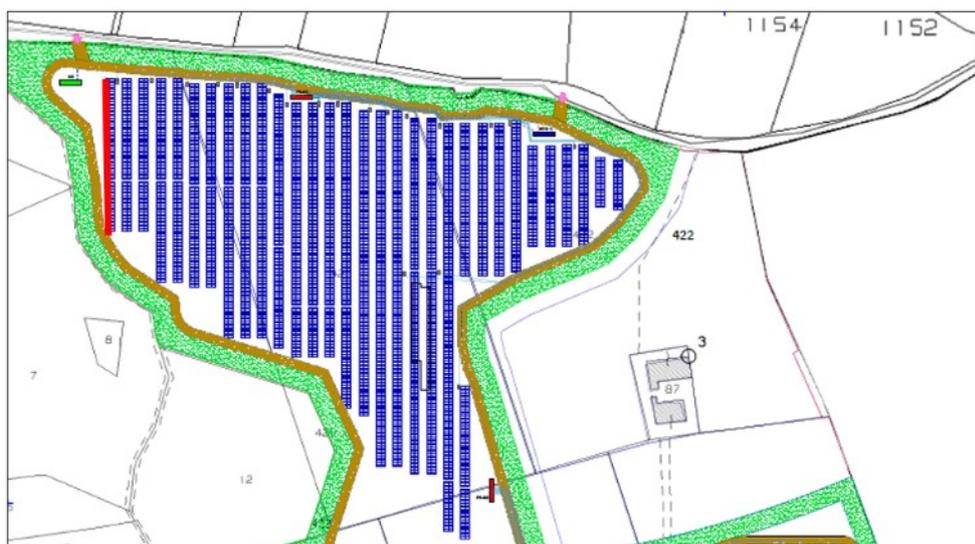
Lotto A (Profilo: linea rossa direzione Nord-Sud)
